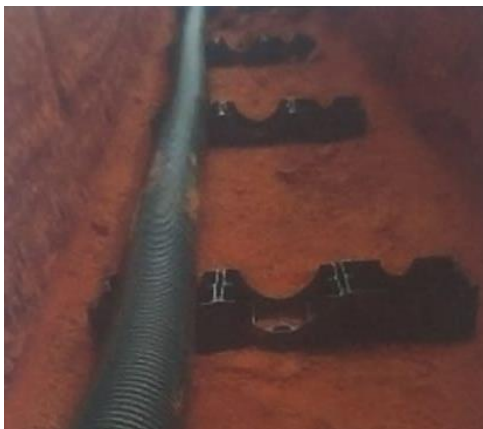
Início da Execução da Montagem dos Espaçadores -
